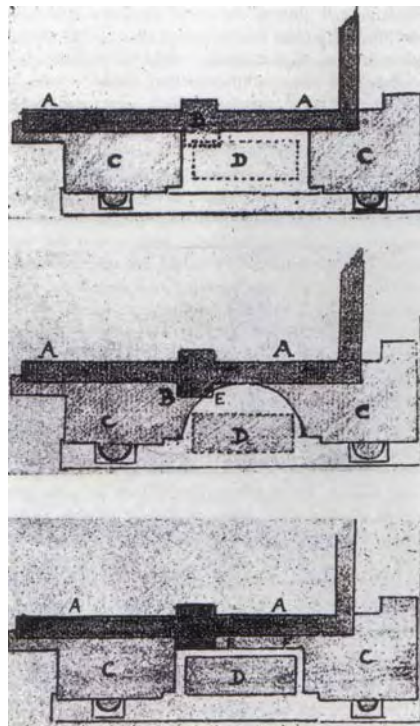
Alternativas para a conformação dos nichos da fachada principal segundo Ricci. Observamos nelas a parede de tijolos existente (A), o pilar existente saliente (B), as pedras do revestimento externo de Alberti (C) e o sarcófago a ser instalado (D) (TAVERNOR, 1998, p. 64).
